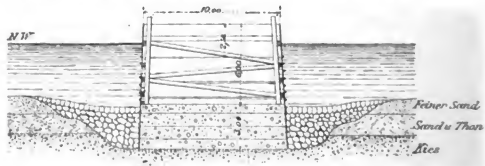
Zum Aufbau des Mauerwerks fertige Mantelgründung.
